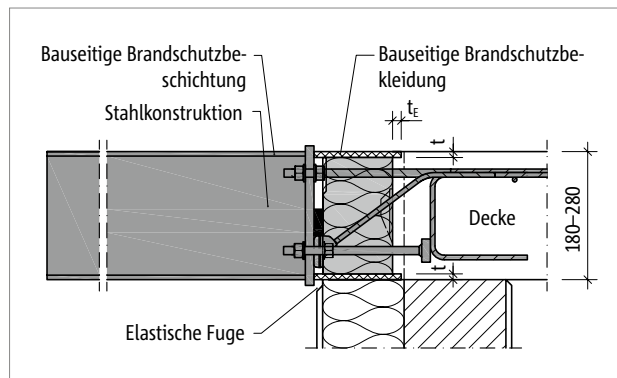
Schöck Isokorb® XT Typ SK: Bauseitige Brandschutzbekleidung für den Isokorb®, brandschutzbeschichtete Stahlkonstruktion; Schnitt
